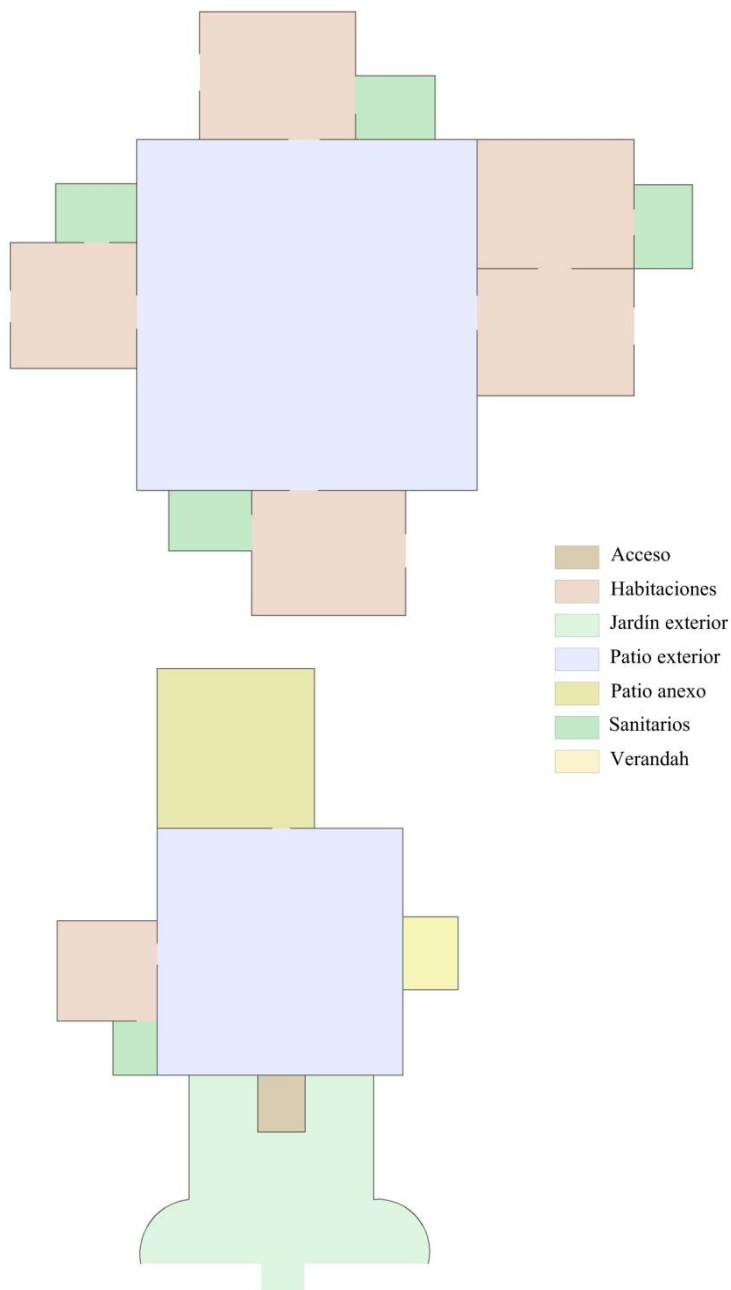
Plano de planta baja. Guesthouse en Kapur Solar Farms
